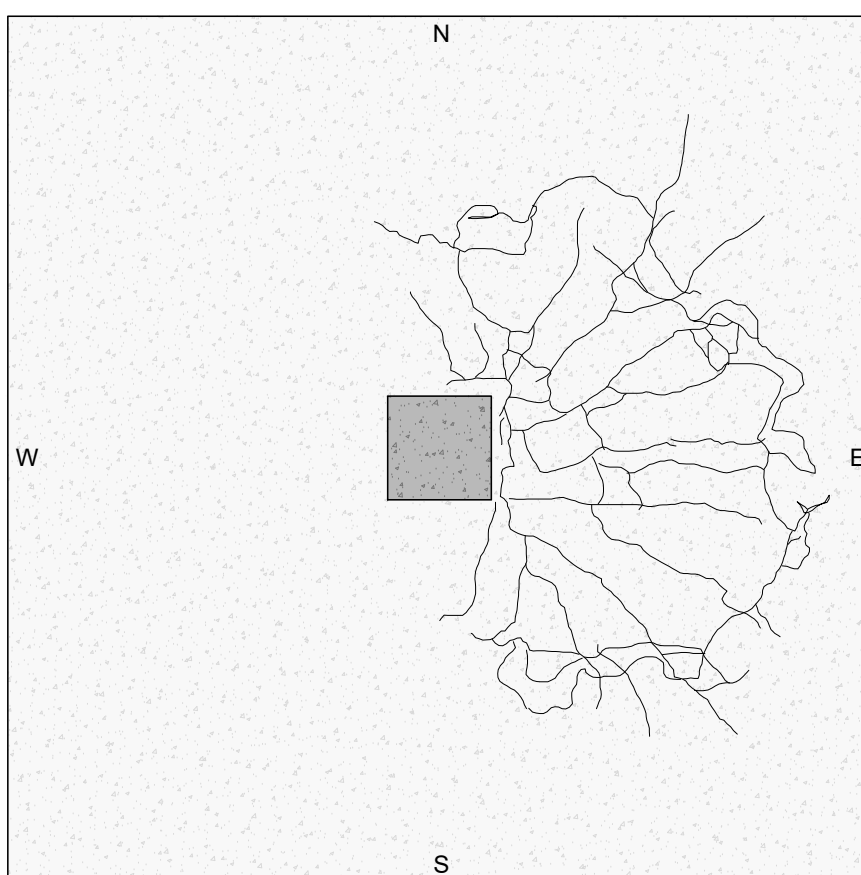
Padrão de fissuração da laje LRSS
